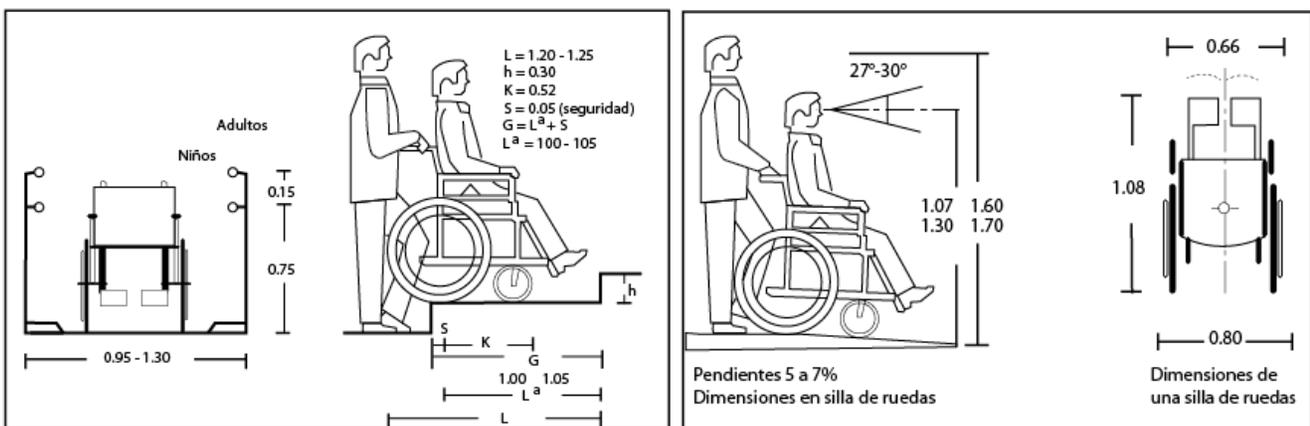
Dimensiones necesarias para una silla de ruedas
